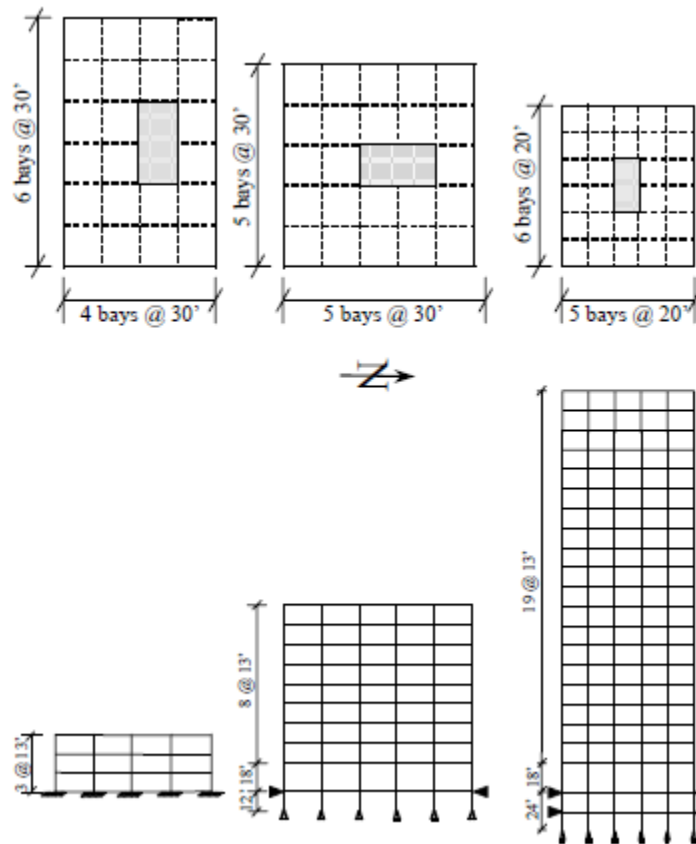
Planta y elevación de los modelos de 3, 9 y 20 niveles (Fema 355C, 2000).
